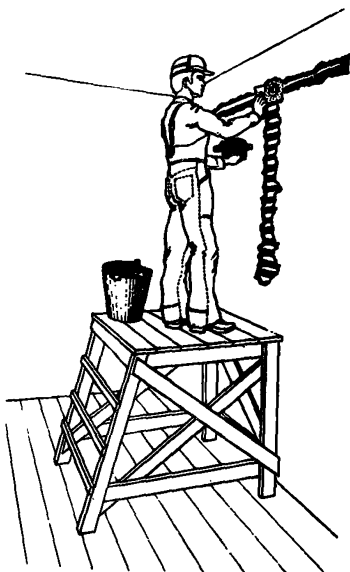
Установка и крепление соединительных коробок и деталей крепления под приборы
